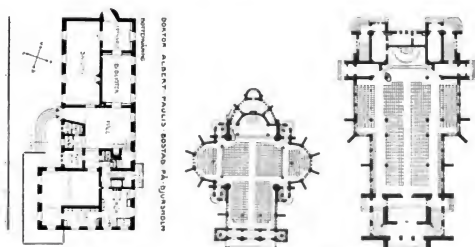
, 142, 143. Plan von Albert Pauli's Wohnhaus. Djursholm. Plan einer projektierten Kirche auf Hvita Berget in Stockholm. Plan einer projektierten Kirche in Örnsköldsvik.
